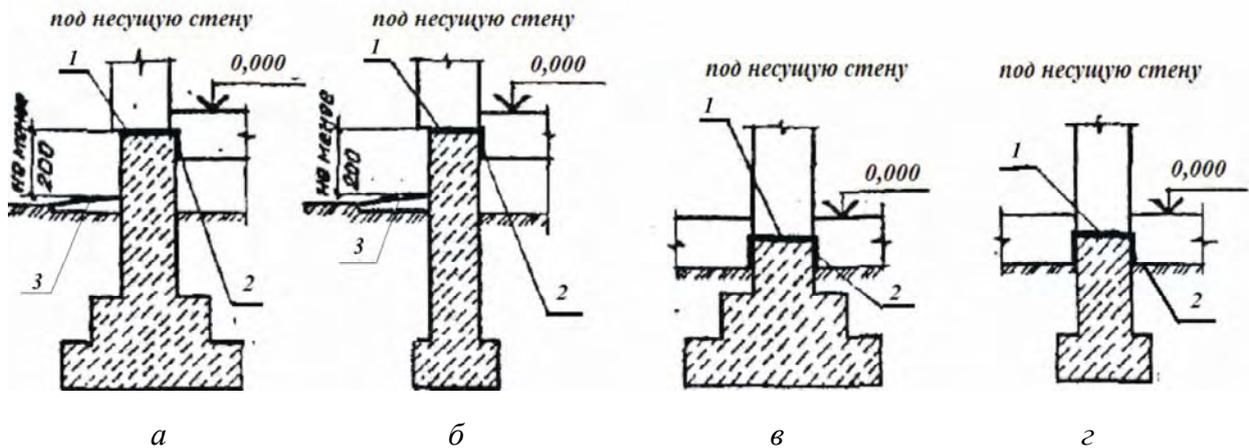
Монолитные фундаменты в зданиях без подвала: а, б — под наружные стены; в, г — под внутренние стены: 1 — два слоя толя на битумной мастике; 2 — окраска горячим битумом (2 раза); 3 — бетонная отмостка
